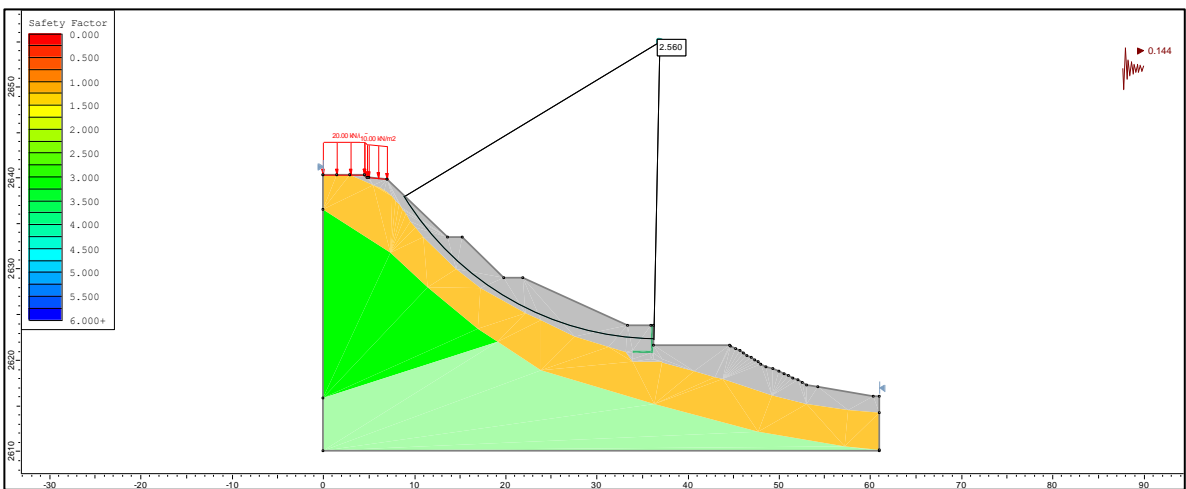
Sección 3-3' con obras Alt. 2 condición pseudoestática y con drenaje $ru=0.1$
